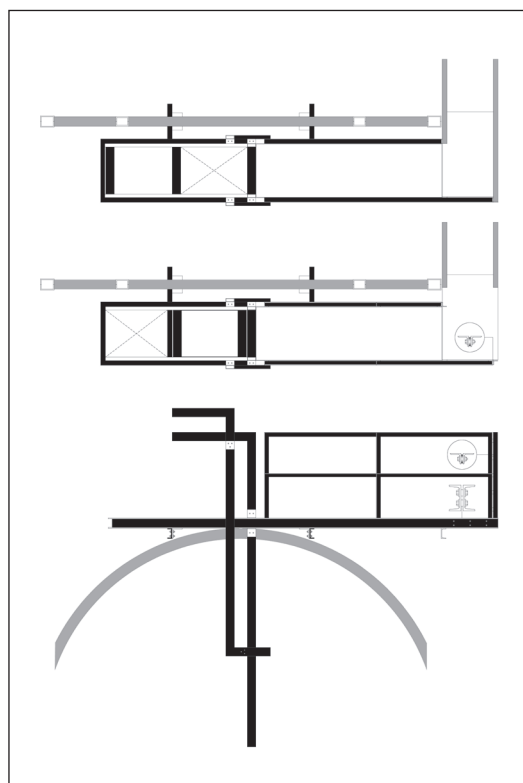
Plano de detalle del nuevo acceso. Alzado y plantas.
